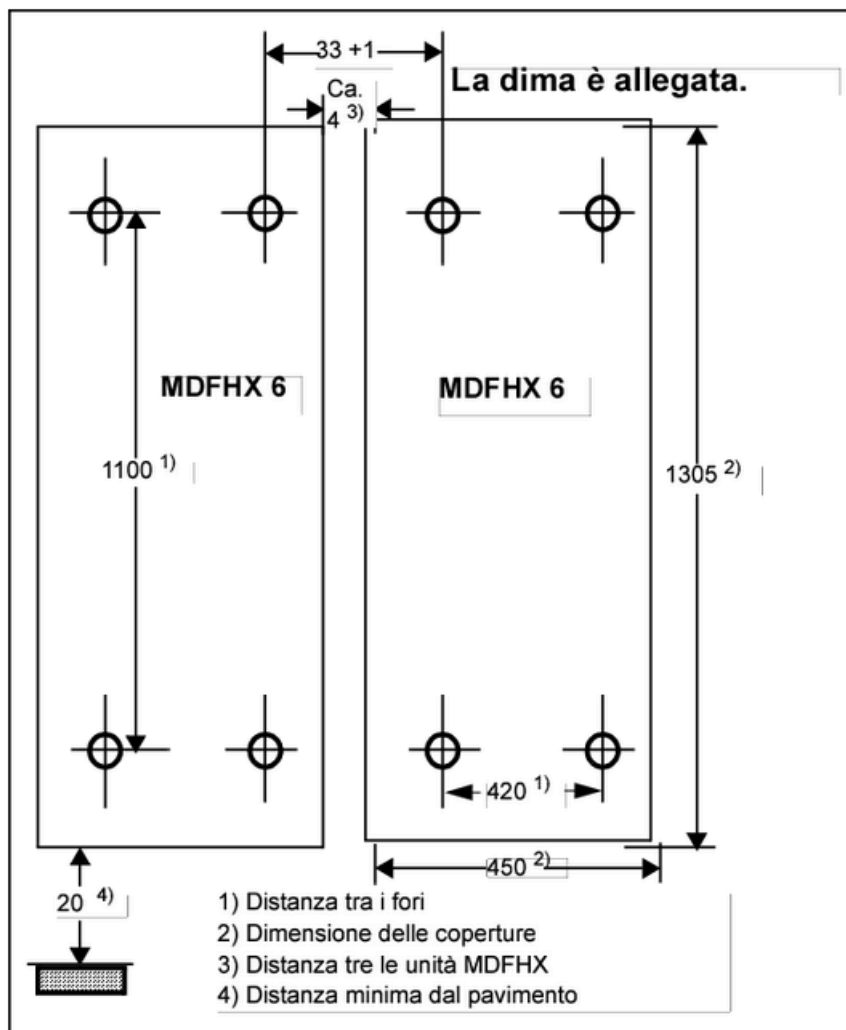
Schema del montaggio a parete dell'MDFHX 6
